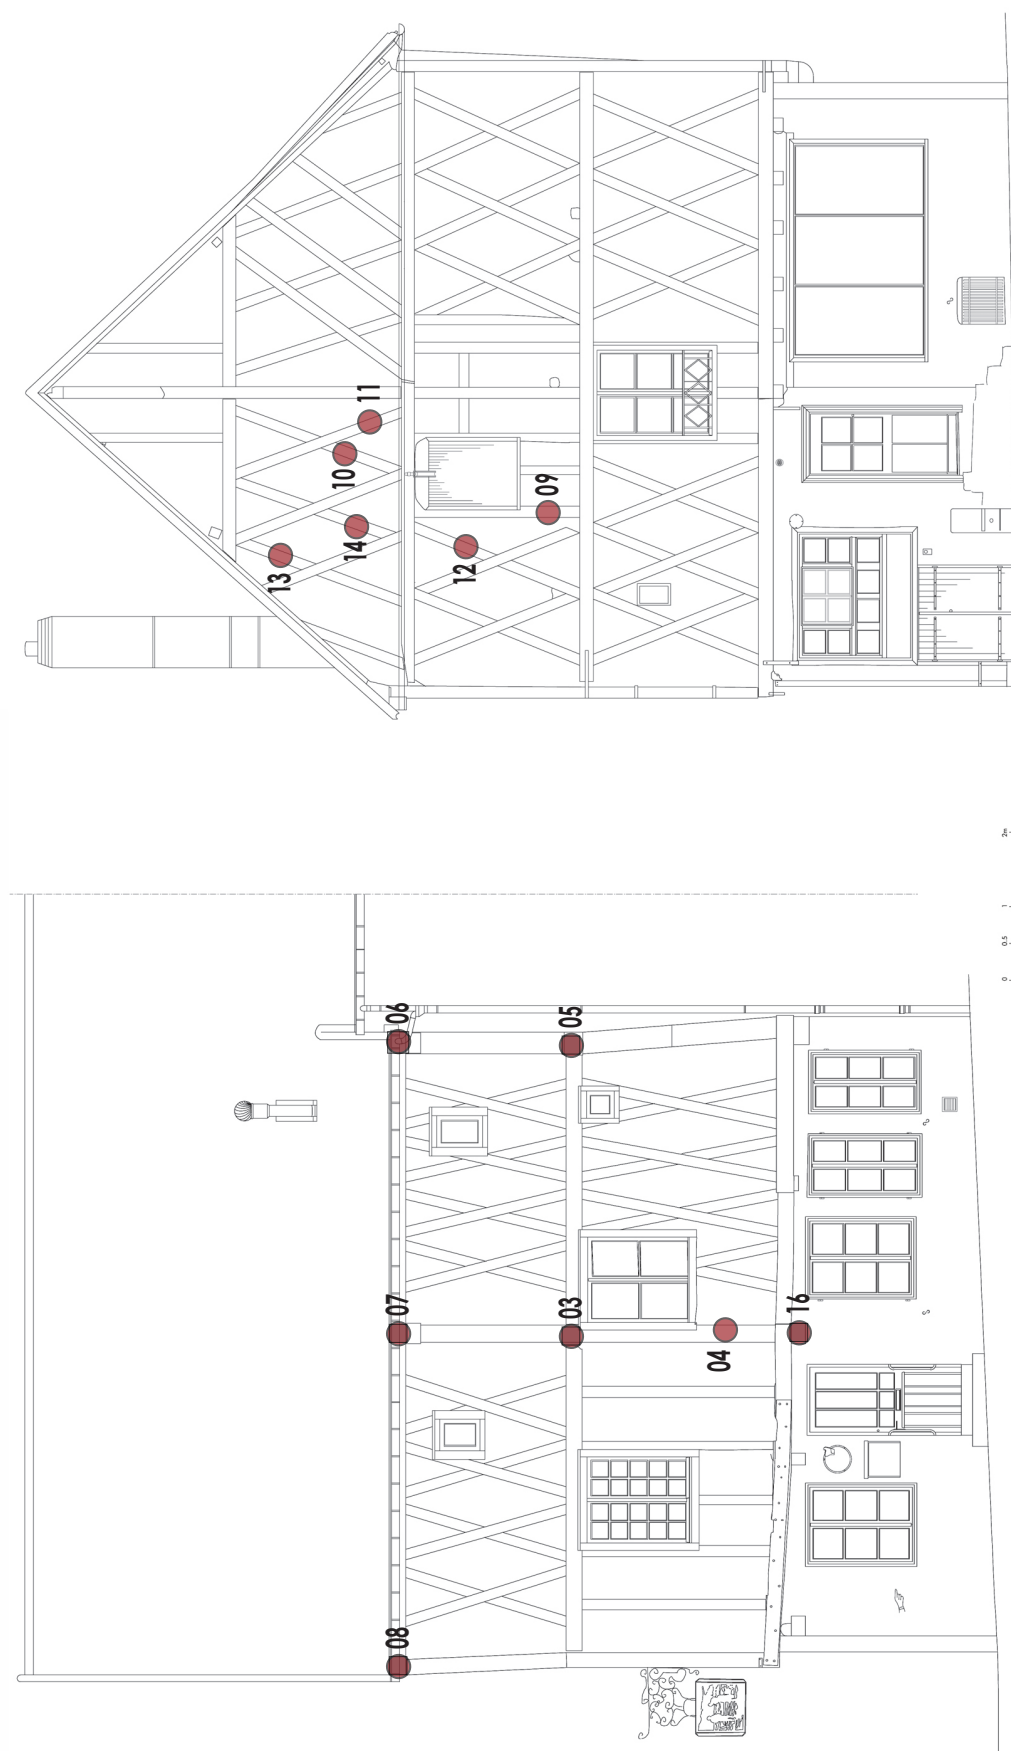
Façade Nord, pignon vu depuis la place Saint -Jean : état en février 2014 et au début du XX^e siècle (s.d.) - Façade Ouest, gouttereau vu depuis la rue du marché.
